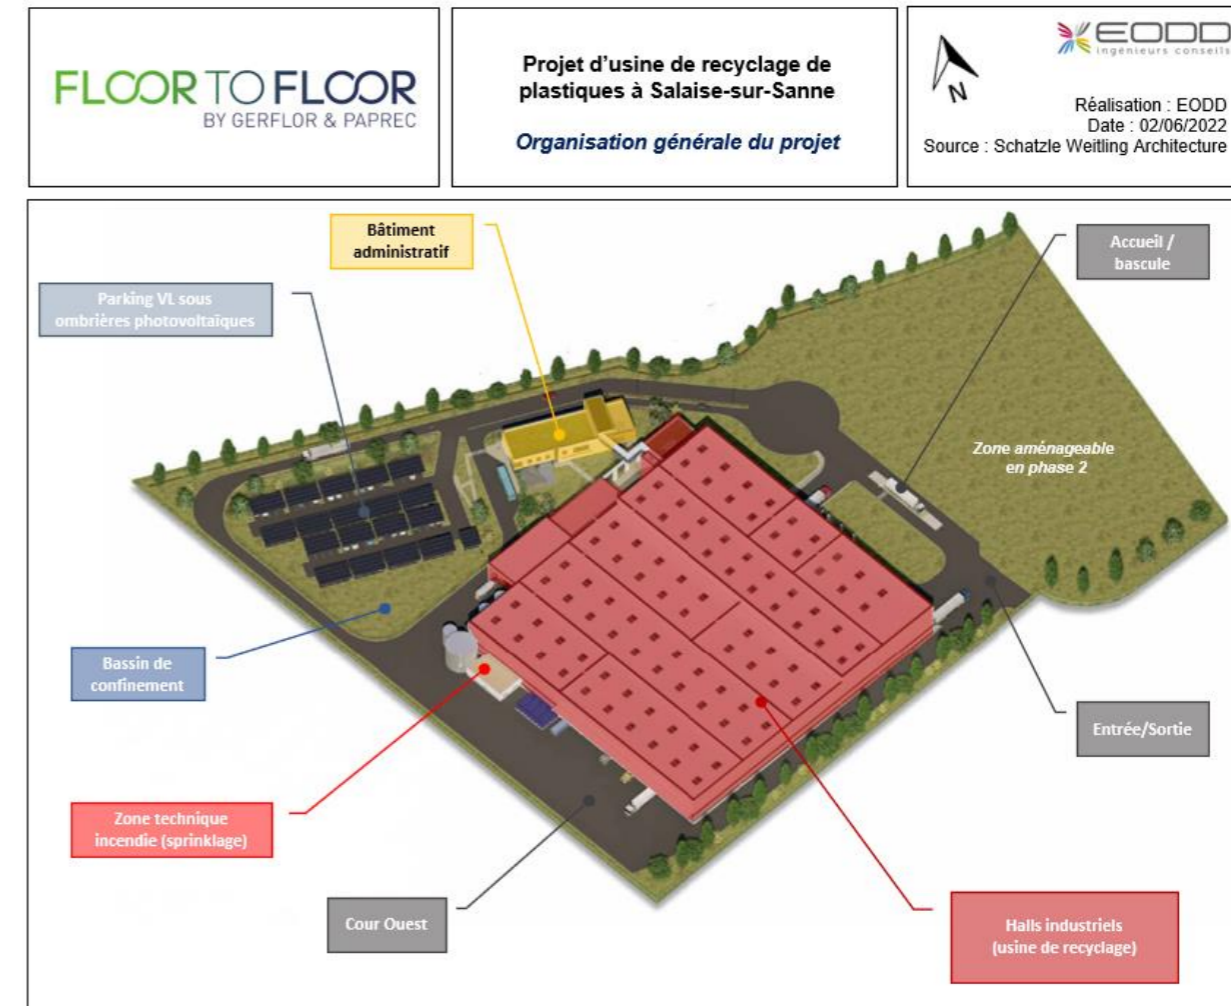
Plan d'organisation générale du projet Floor to Floor (vue axonométrique)
